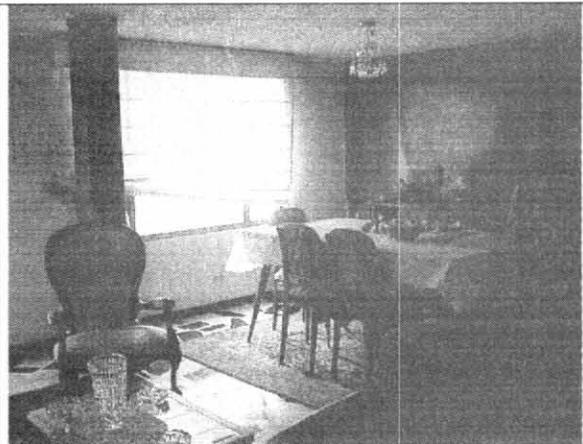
Interior del inmueble, sin daños estructurales que evidencien mal comportamiento estructural.
